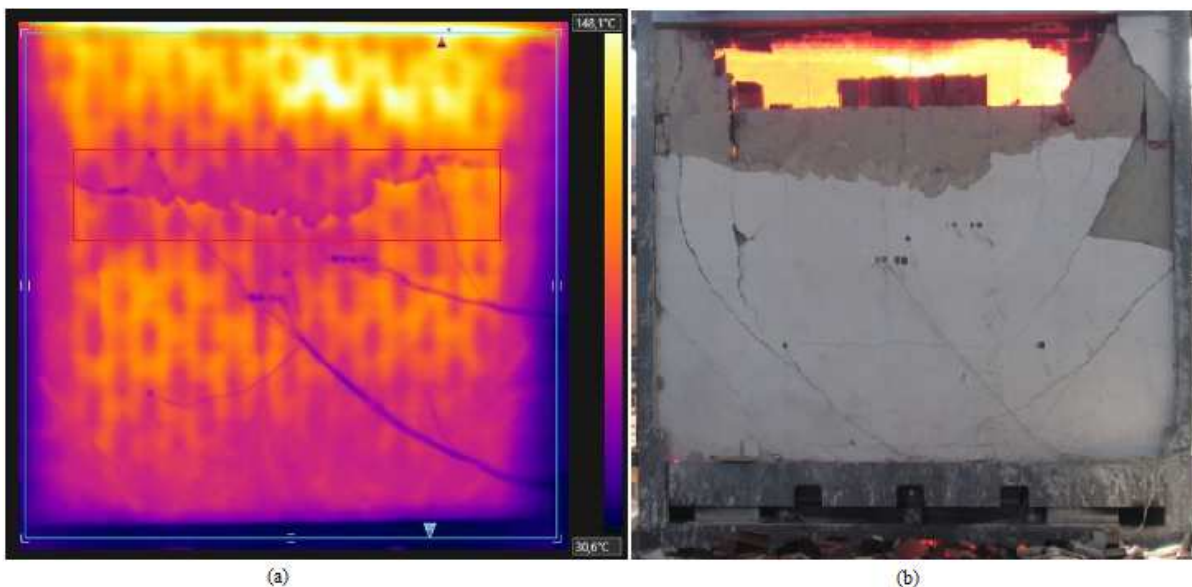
(a) Fissura horizontal e (b) Estabilidade estrutural comprometida
